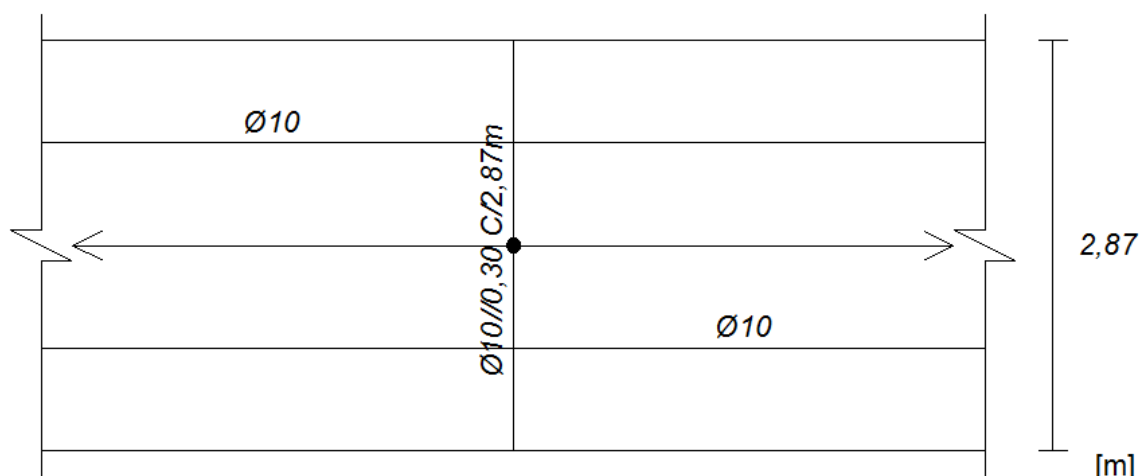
Pormenorização das armaduras de pré-esforço transversal e longitudinal da laje em planta (Marques, J. 2013)
